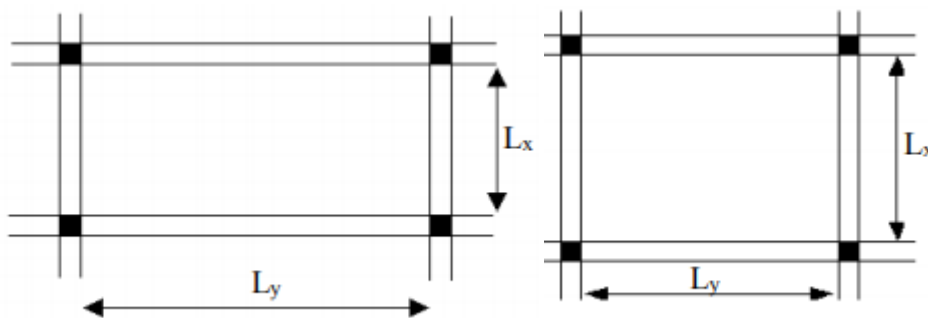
Dimensions d'un panneau de dalle pleine.
